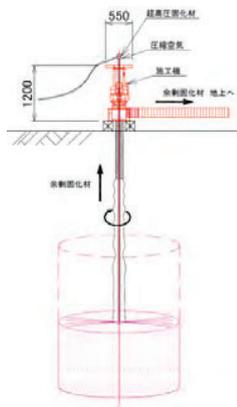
施工概念図②<sup>2)</sup> 写真 4.8. 施工状況<sup>2)</sup>
